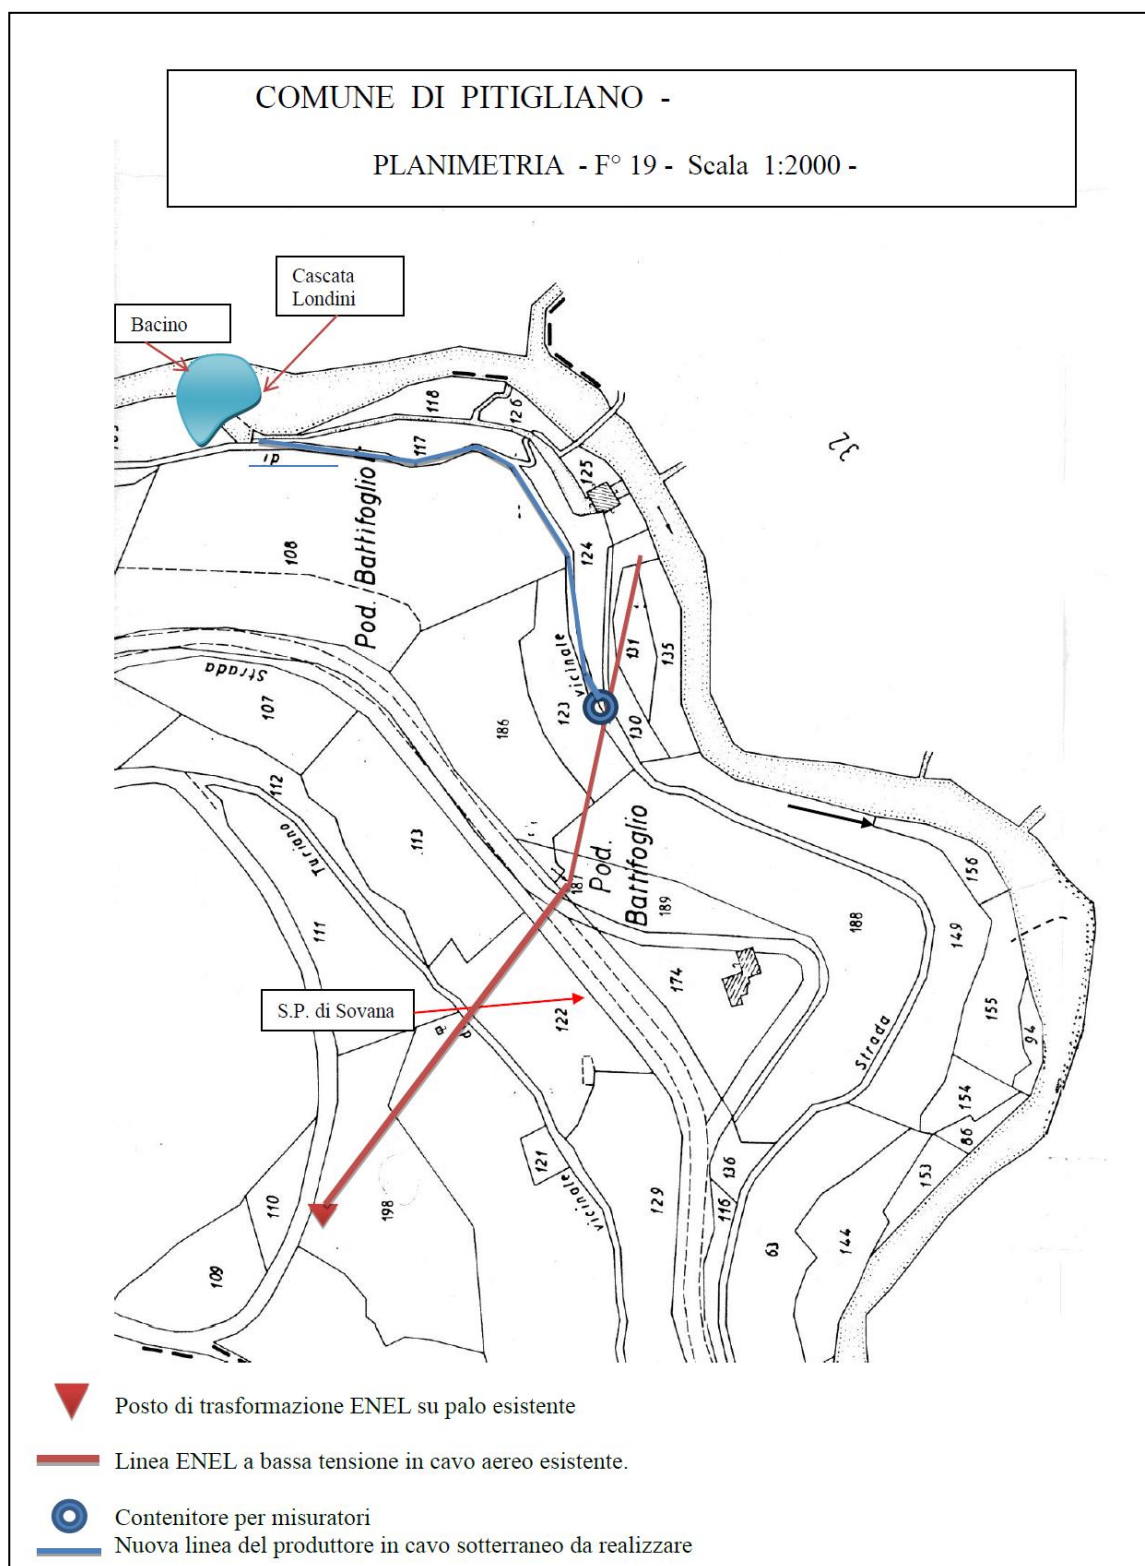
Planimetria con le opere di E-Distribuzione e le opere private
